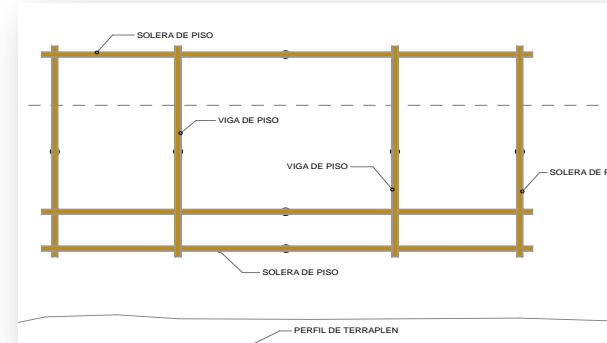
Planta de ubicación de soleras inferiores. Fuente: Investigador.
